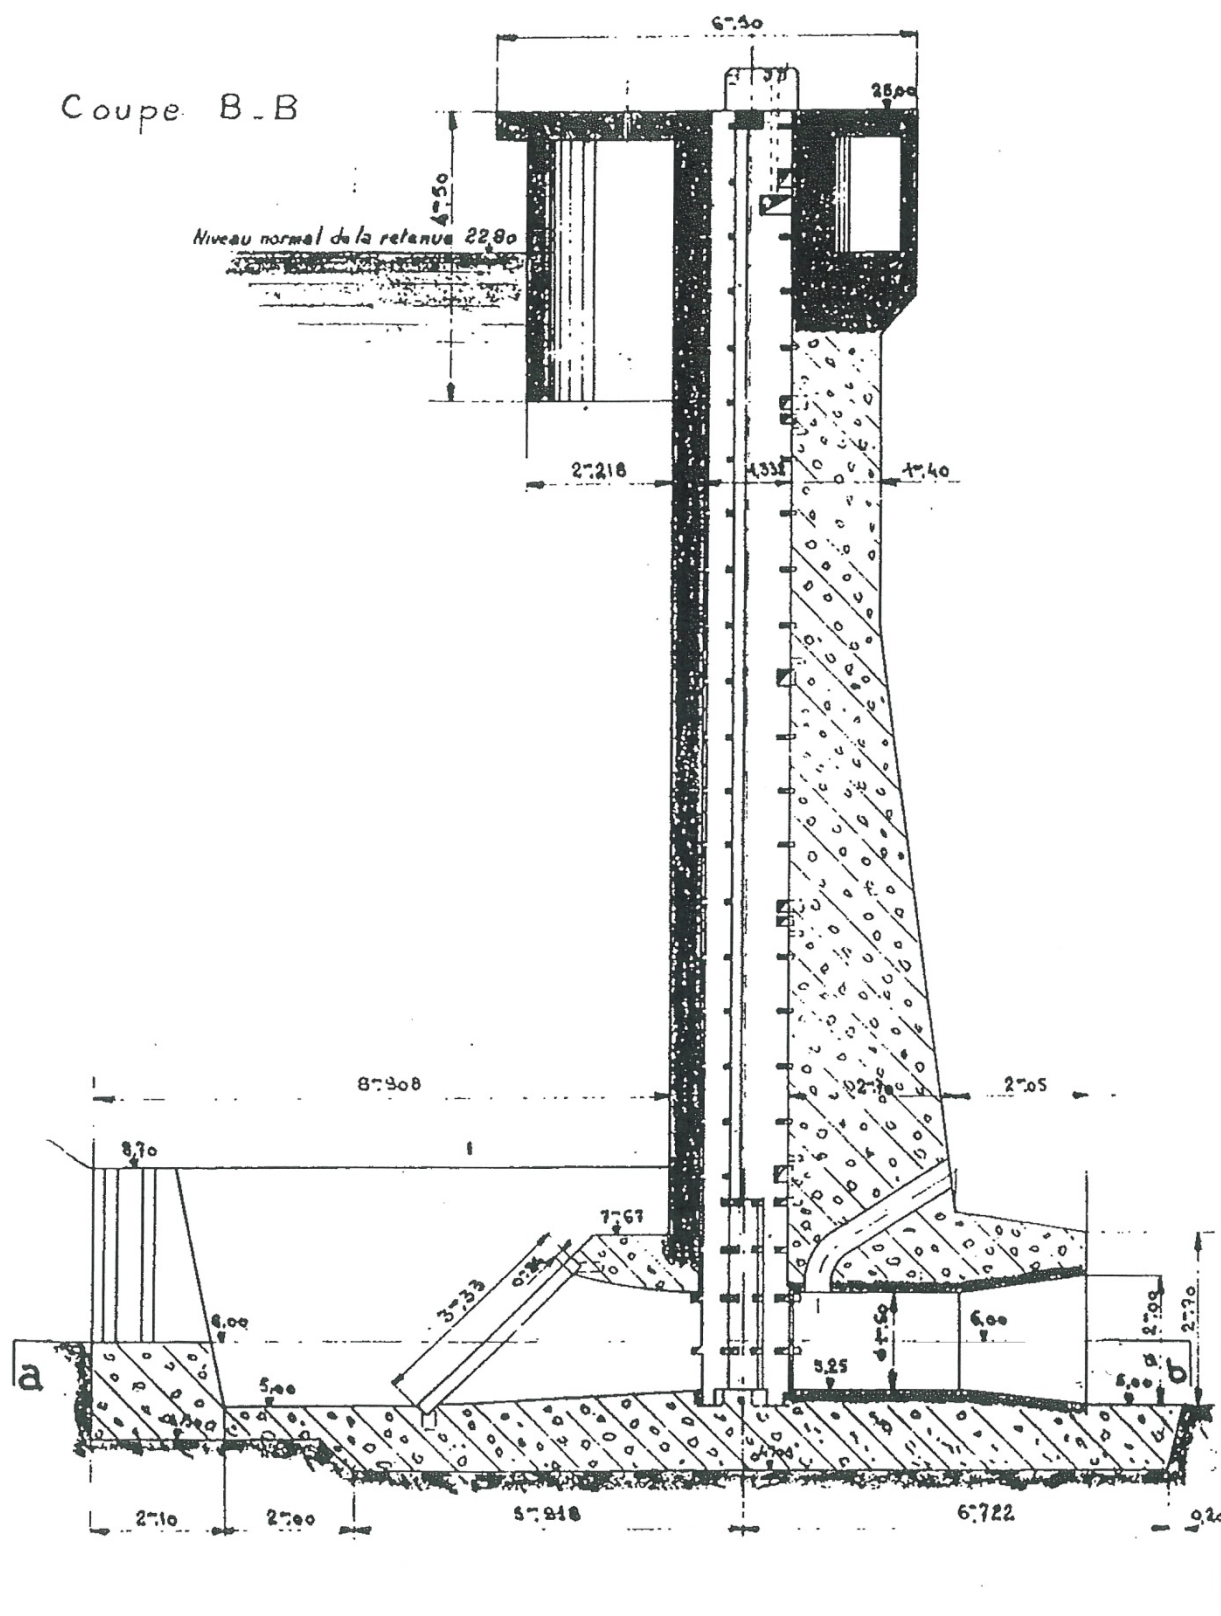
Coupe du barrage au droit de la vidange de fond
